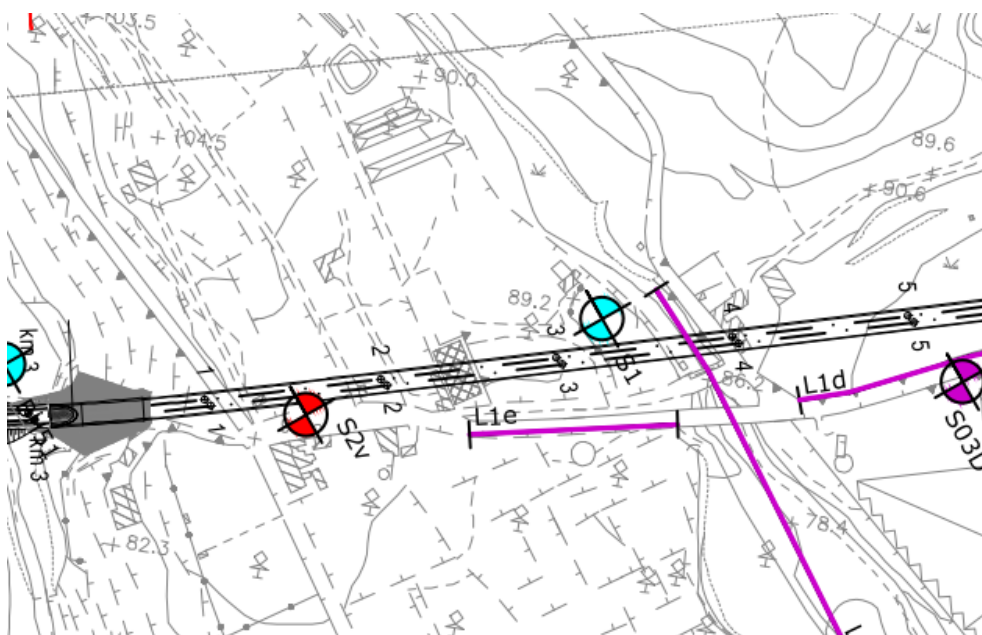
Stralcio planimetrico con ubicazione del sondaggio S1
